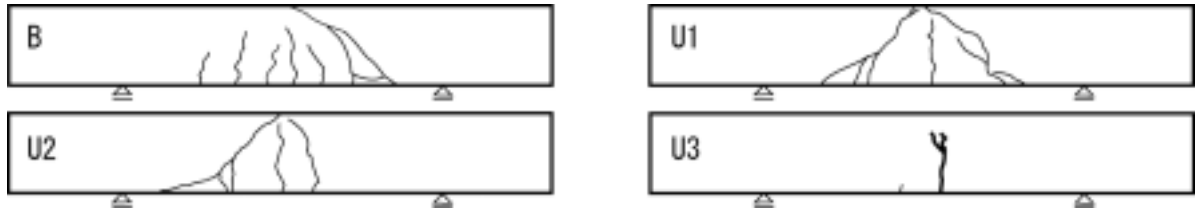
ひび割れ分布図 Dimensions of Test Specimens
